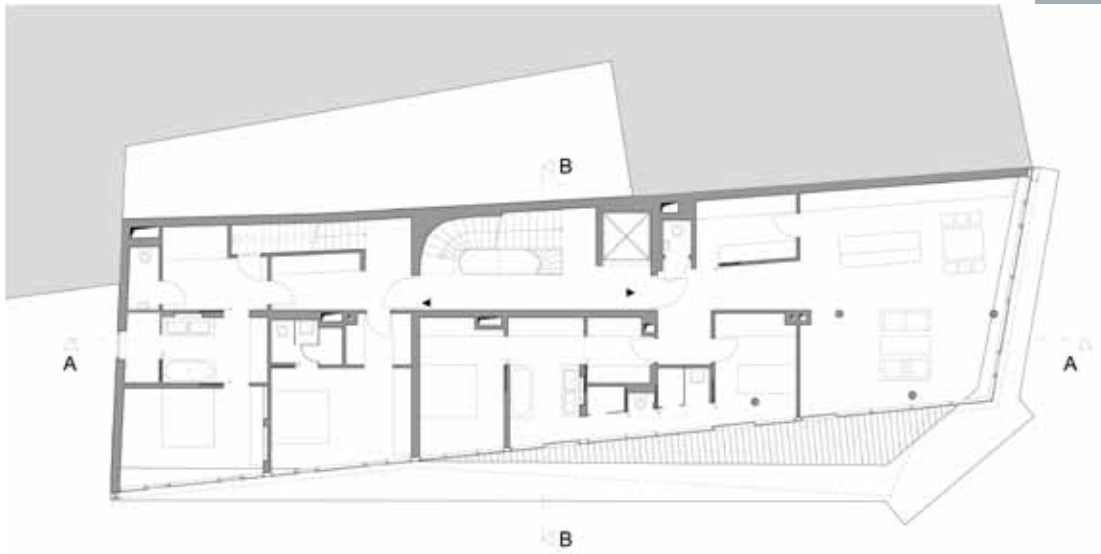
Grundriss 1.DG © Josef Weicheberger Architects
